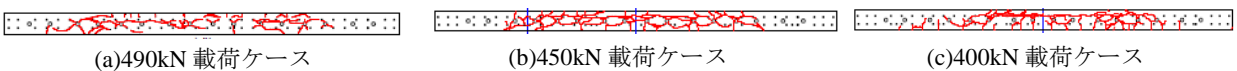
試験での橋軸方向断面のひび割れ性状⁵⁾
